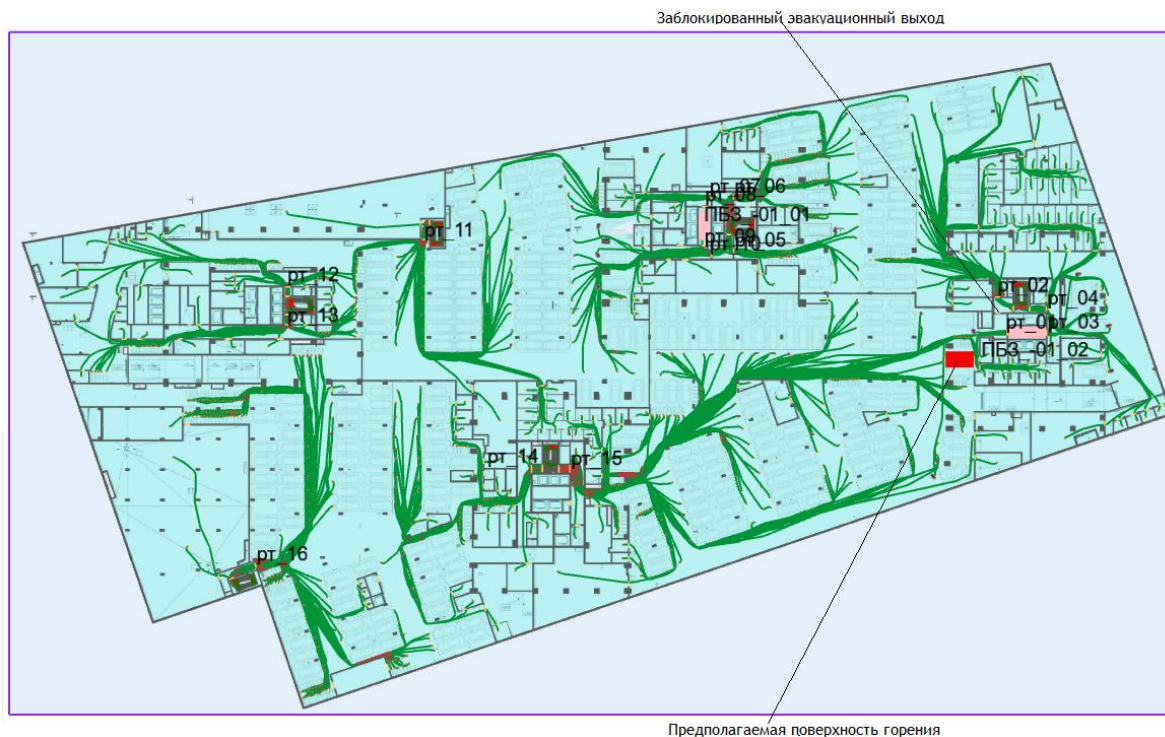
План минус 1-го этажа и нанесенная на него расчетная (принципиальная) схема эвакуации
